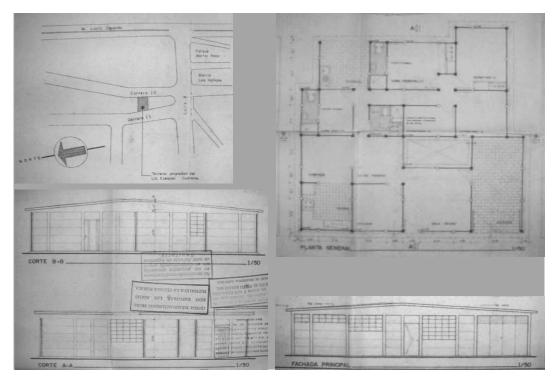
Viviendas tipo quinta, sobresalen los retiros de frente y laterales, el antejardín, la estructura de pórtico en concreto armado, losas nervadas planas —entrepiso— e inclinadas en cubierta con teja criolla.
